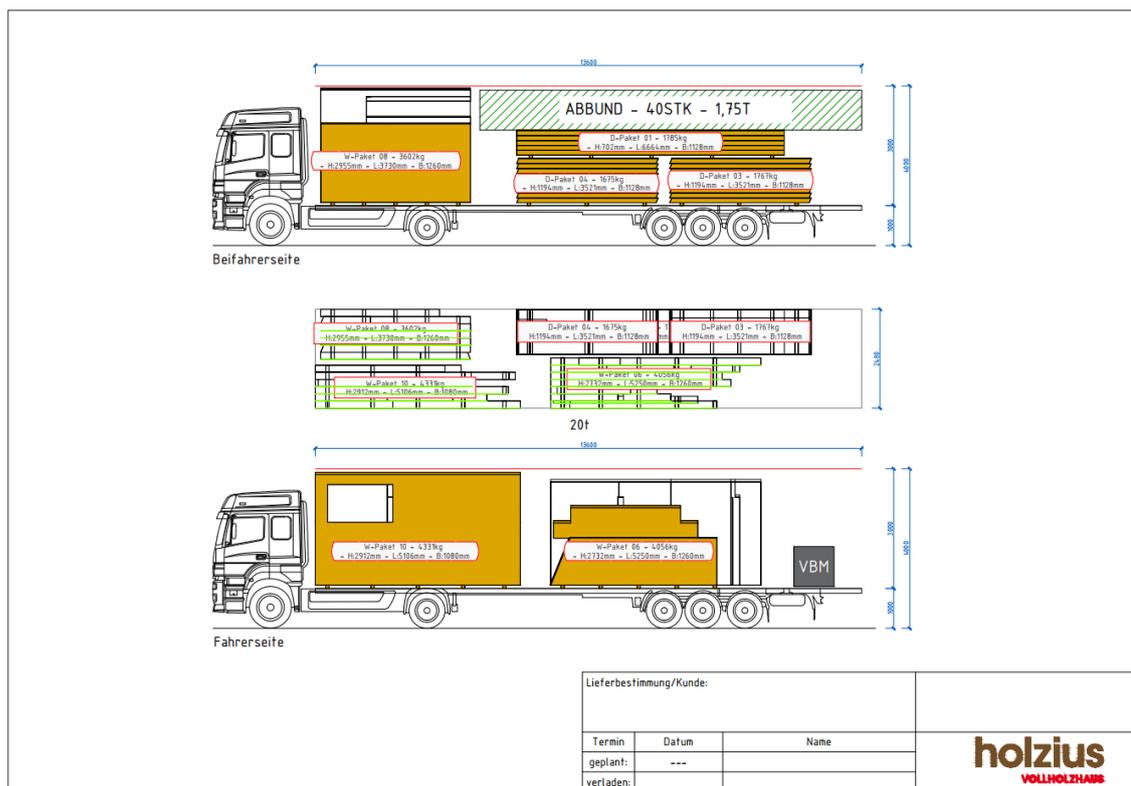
Piano di trasporto per autoarticolati con elementi di parete, solaio e falegnameria
